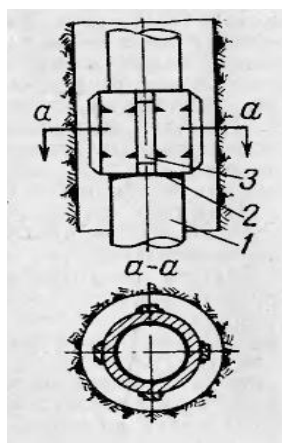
Скоби направляючої системи : 1 – труба; 2 – муфта; 3 - планки.
